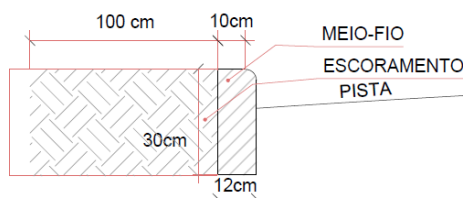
Corte Transversal – Assentamento de Meio-Fio
